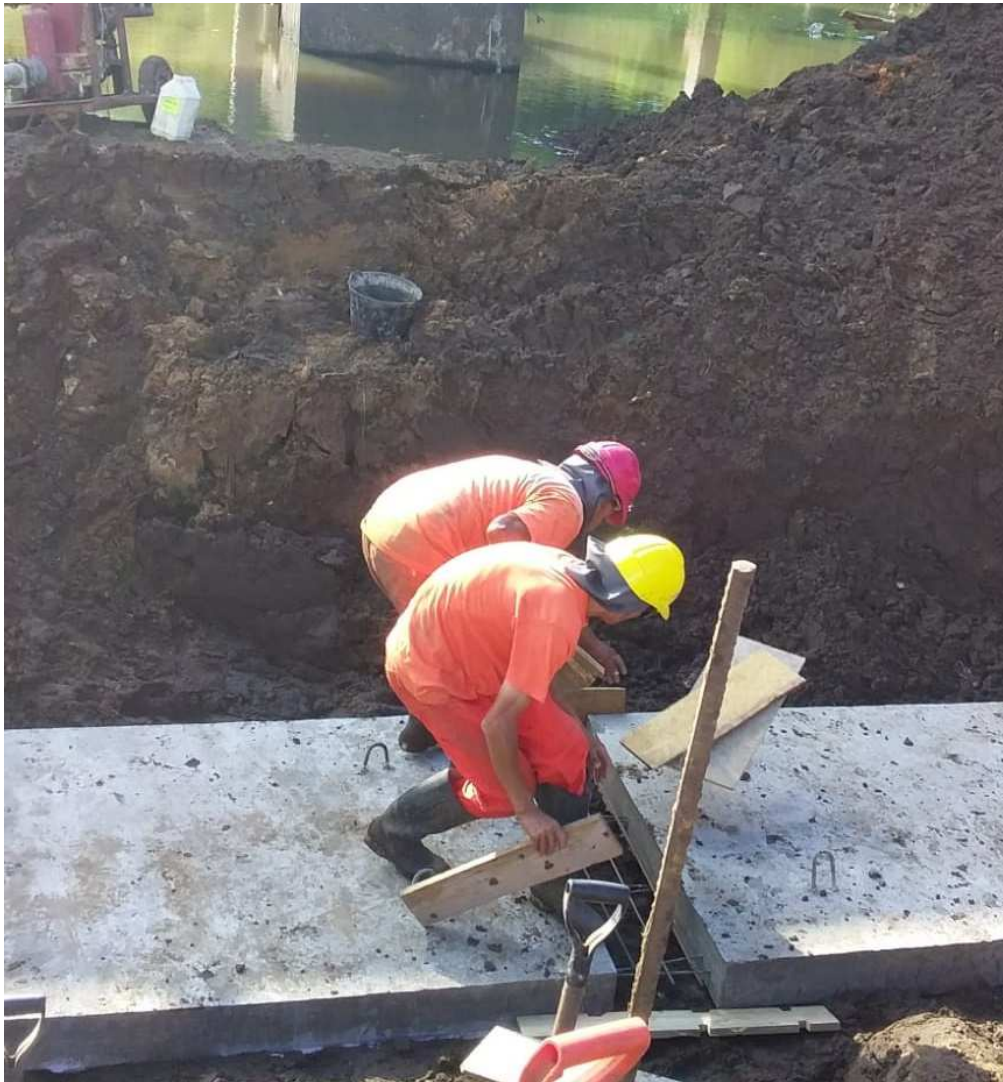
y 6 – Losetas prefabricadas para protección de tubería
